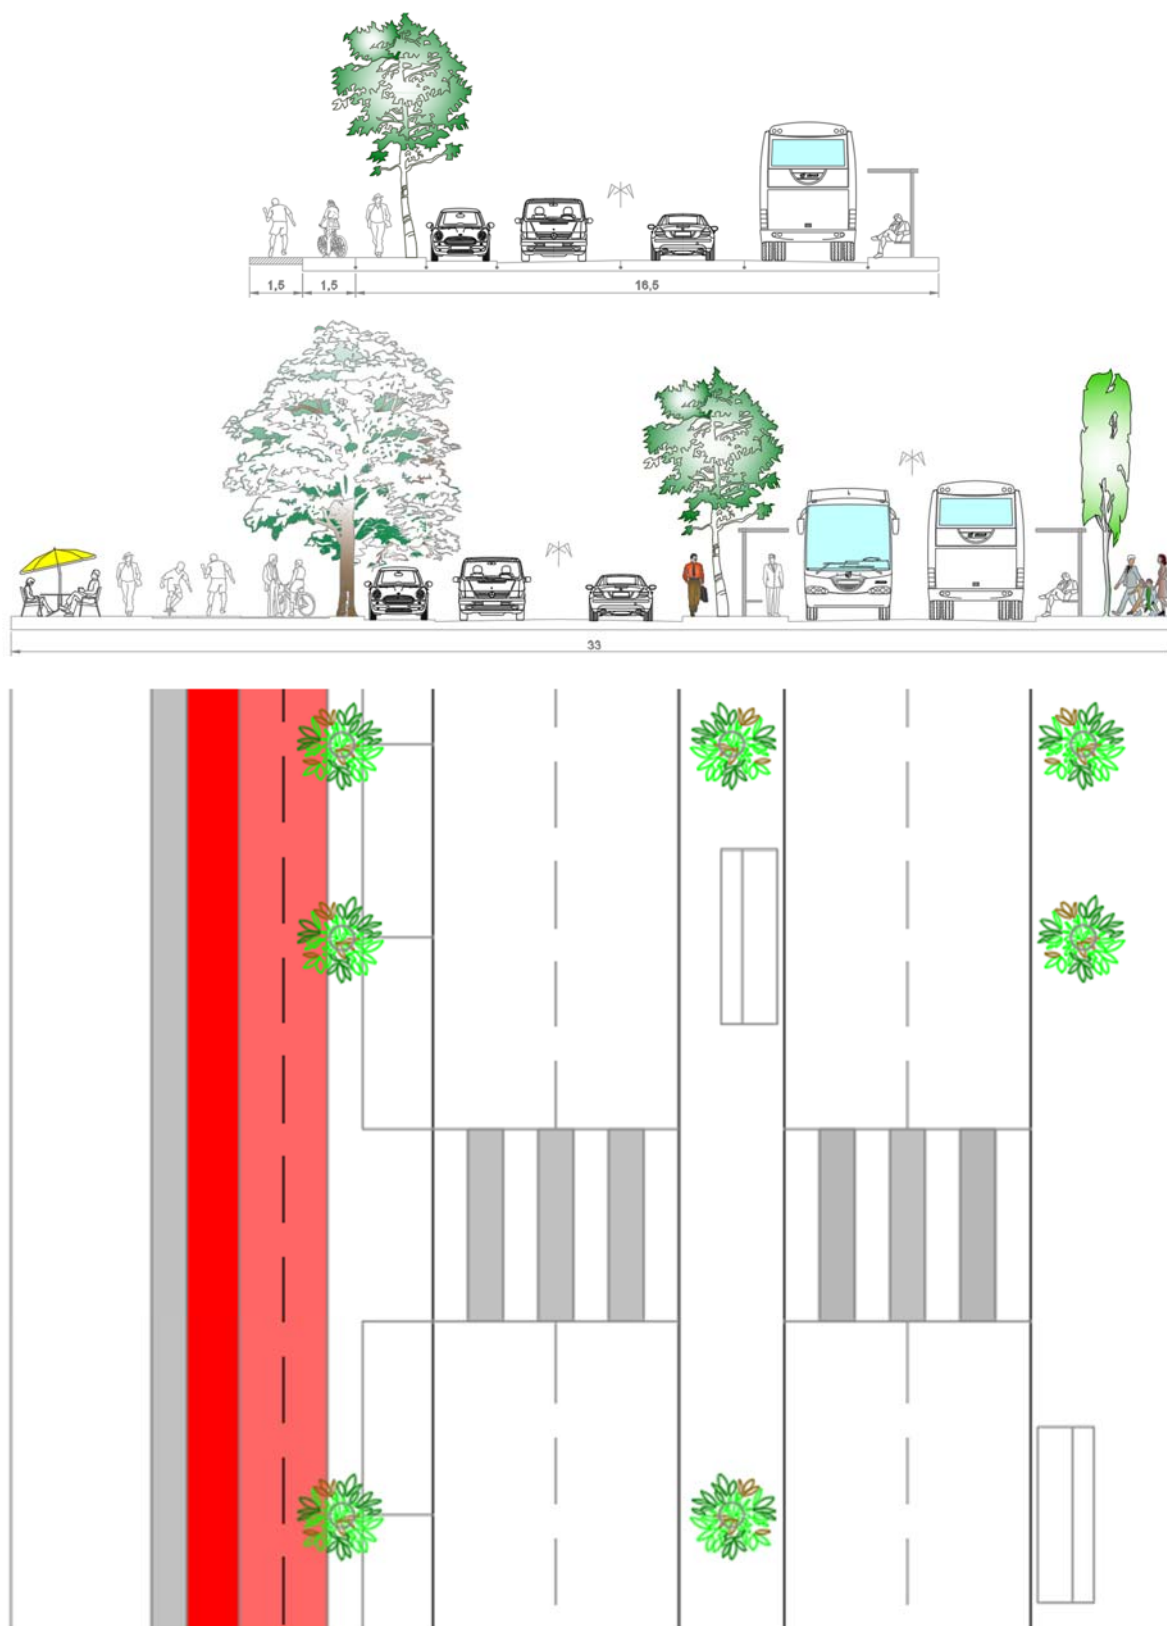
Perfil transversal (em cima) e projeção em planta (em baixo) para a via de 16,5 e 33m (do autor)
